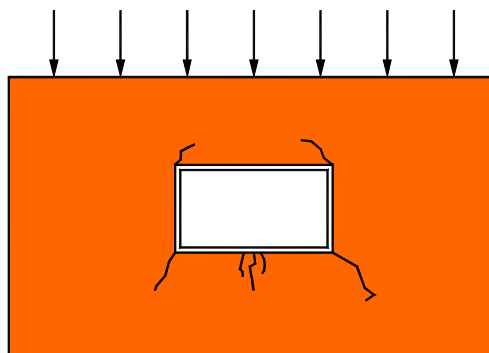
Fissuração teórica no entorno de abertura, em parede solicitada por actuação excessiva de cargas [30]
